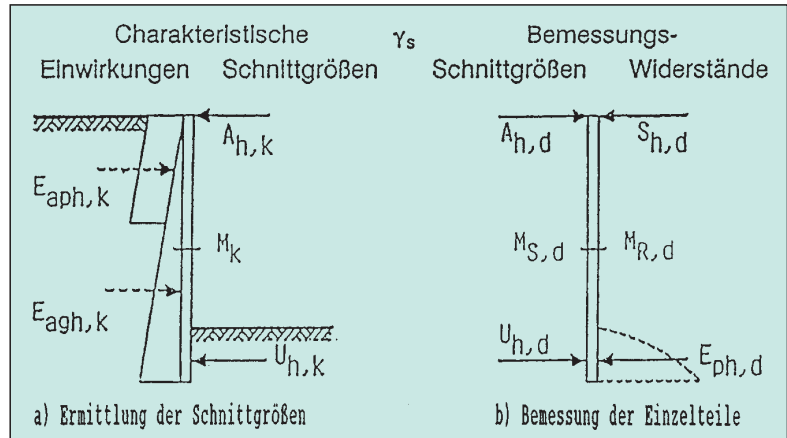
Schnittgrößenermittlung und Bemessung nach DIN 1054
